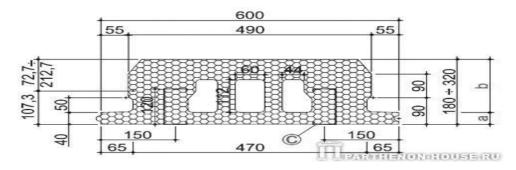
Поперечное сечение несъемной опалубки PLASTBAU (ПЛАСТБАУ) для межэтажных перекрытий и настила крыши.
